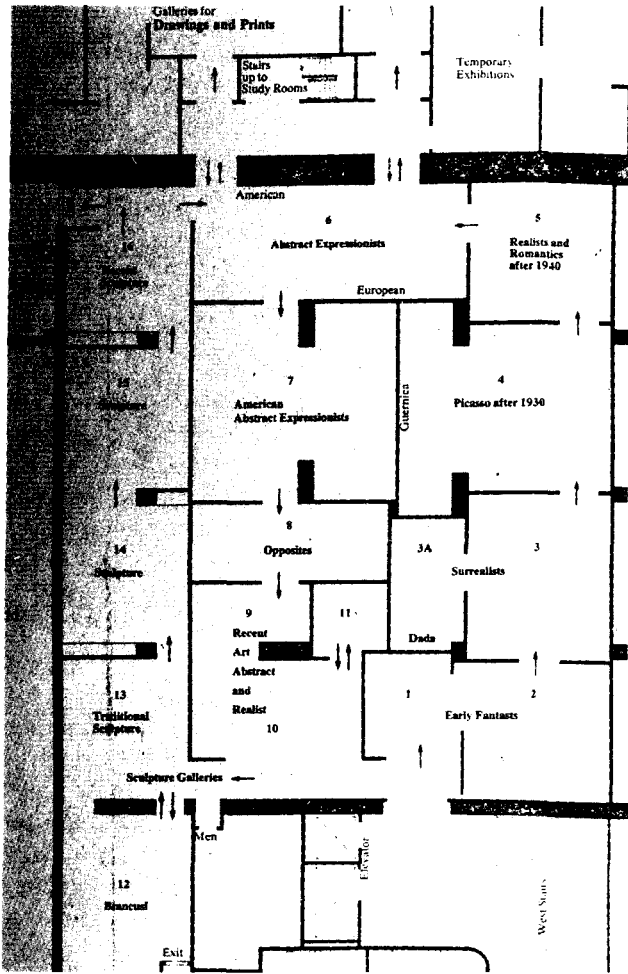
Museo de Arte Moderno de New York: Plano de la 3.^a planta.
